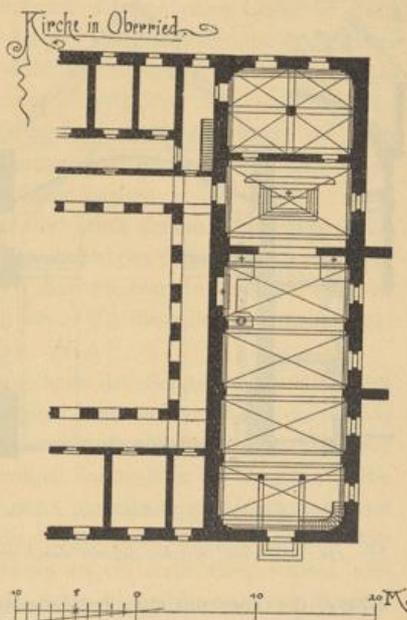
Oberried. Kirche, Grundriss.
